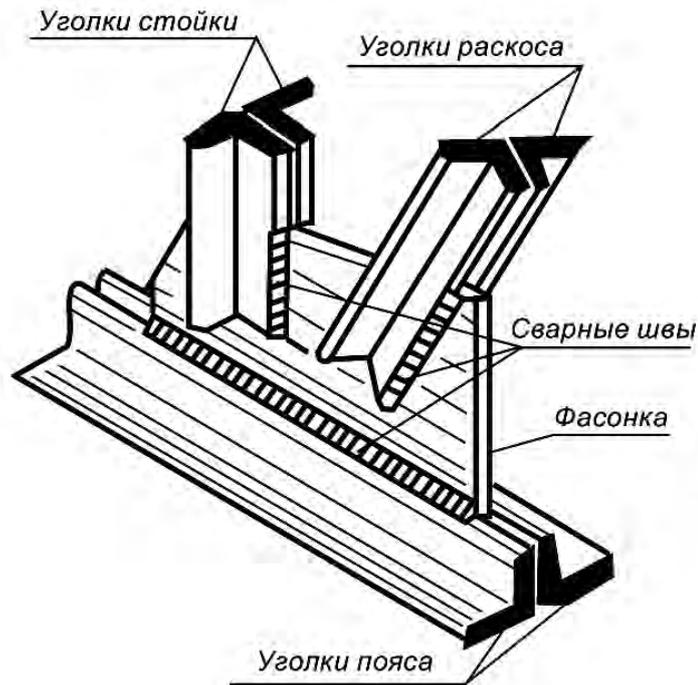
Элементы узла нижнего пояса металлической фермы
